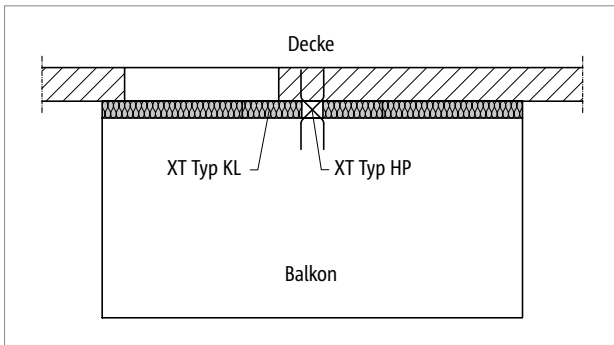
Schöck Isokorb® XT Typ KL: Balkon frei auskragend; optional mit XT Typ HP bei planmäßigen Horizontallasten (z. B. geschlossene Brüstungen)
